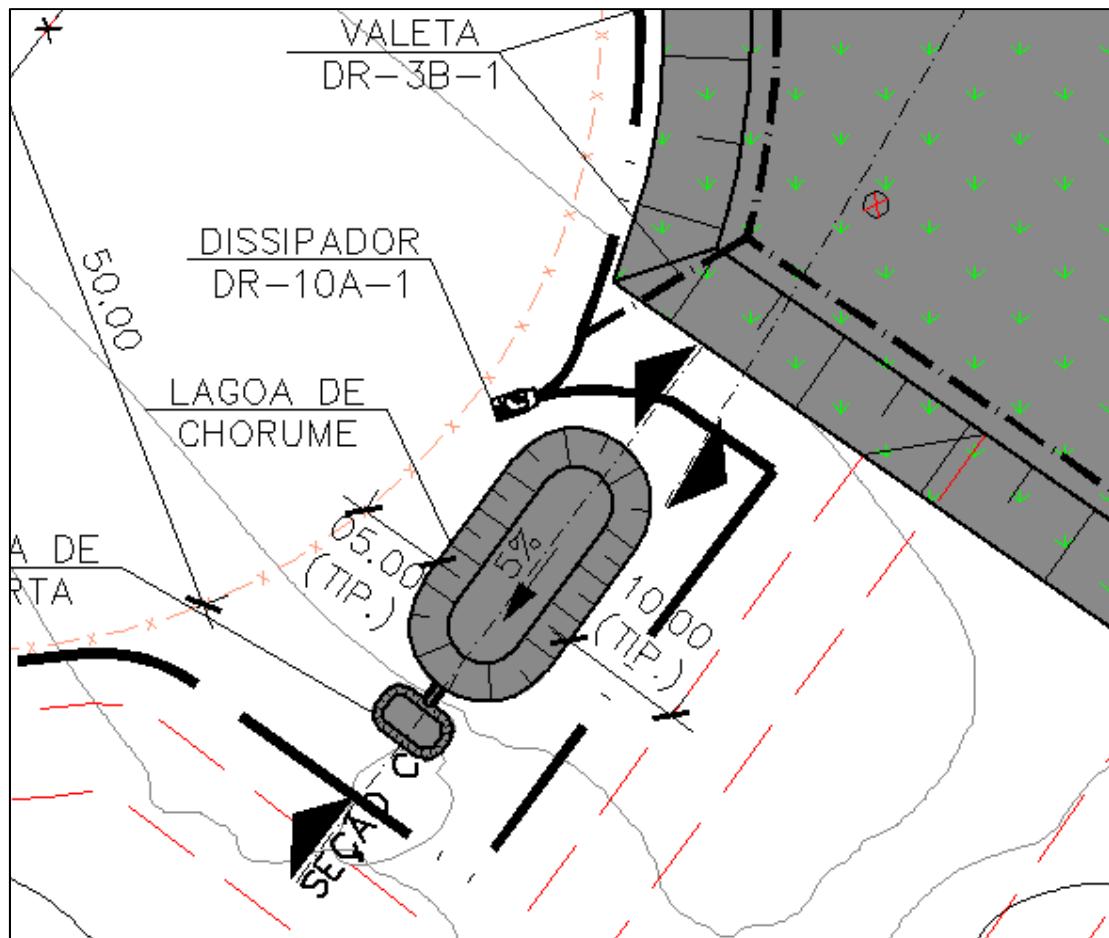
Lagoa de chorume e lagoa de alerta do Lixão de Baixio.
